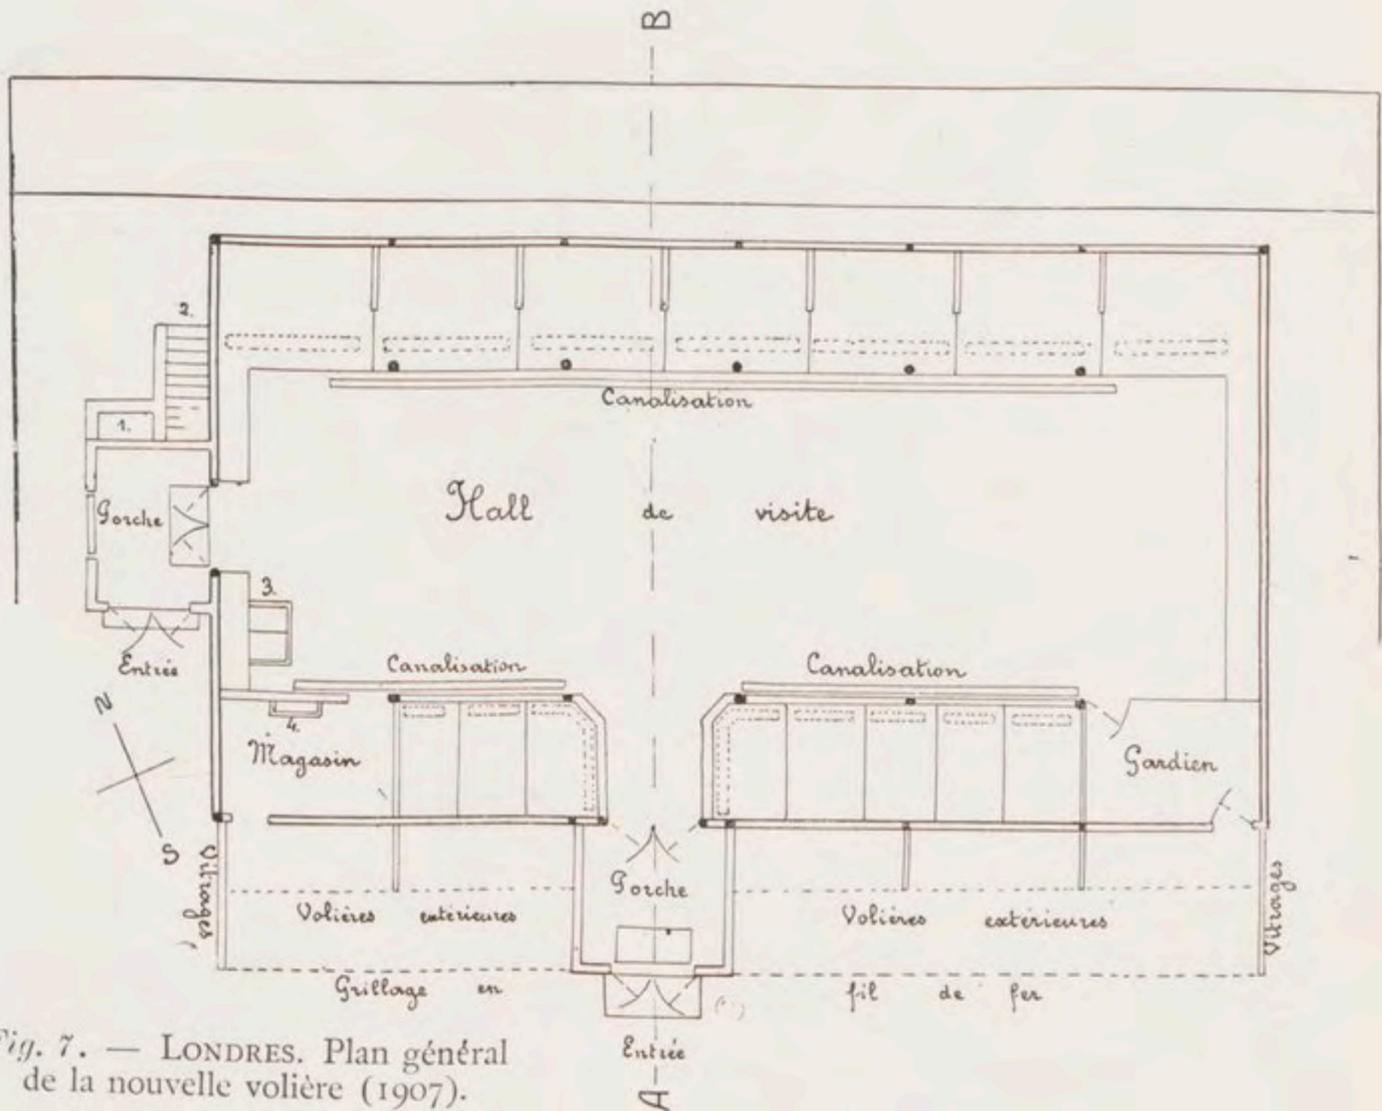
LONDRES. Plan général de la nouvelle volière (1907).
